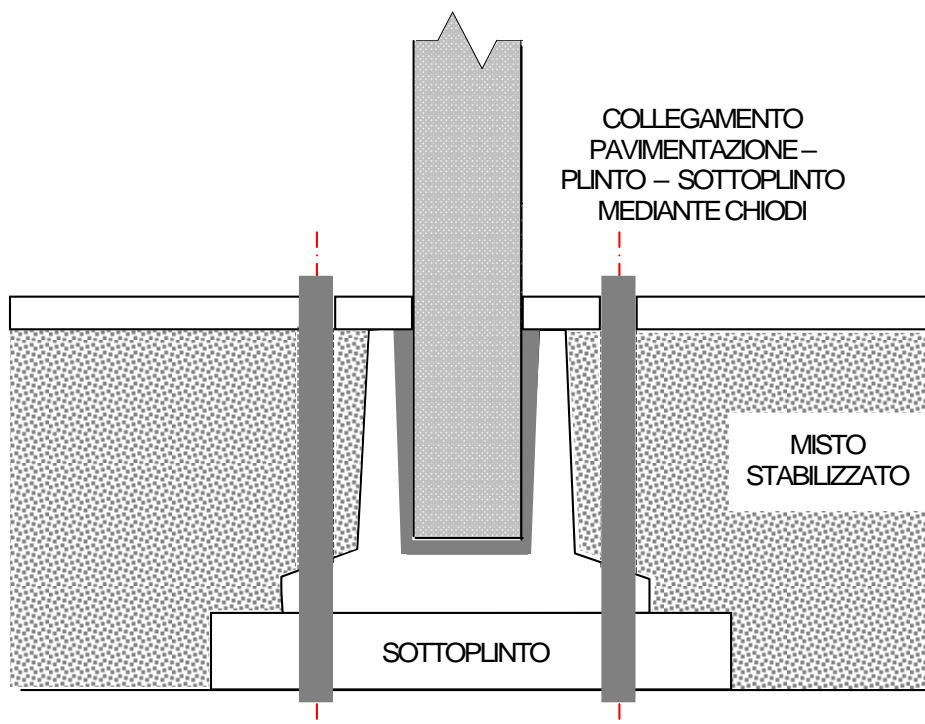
Solidarizzazione della pavimentazione industriale con il plinto ed il sottoplinto
